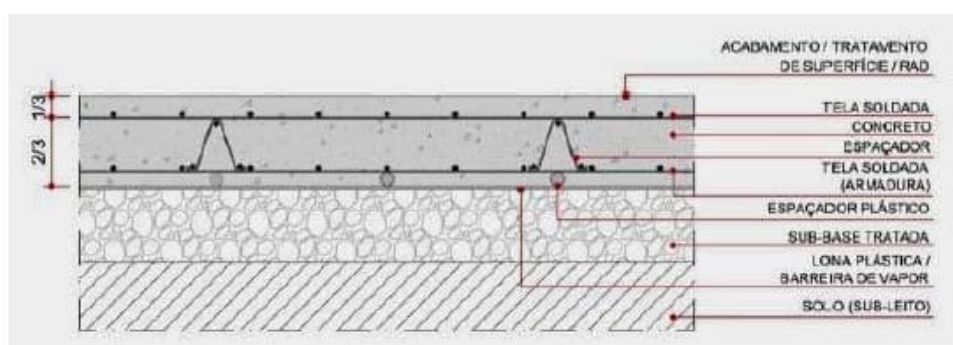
Corte esquemático da estrutura da seção tipo de pavimento rígido
